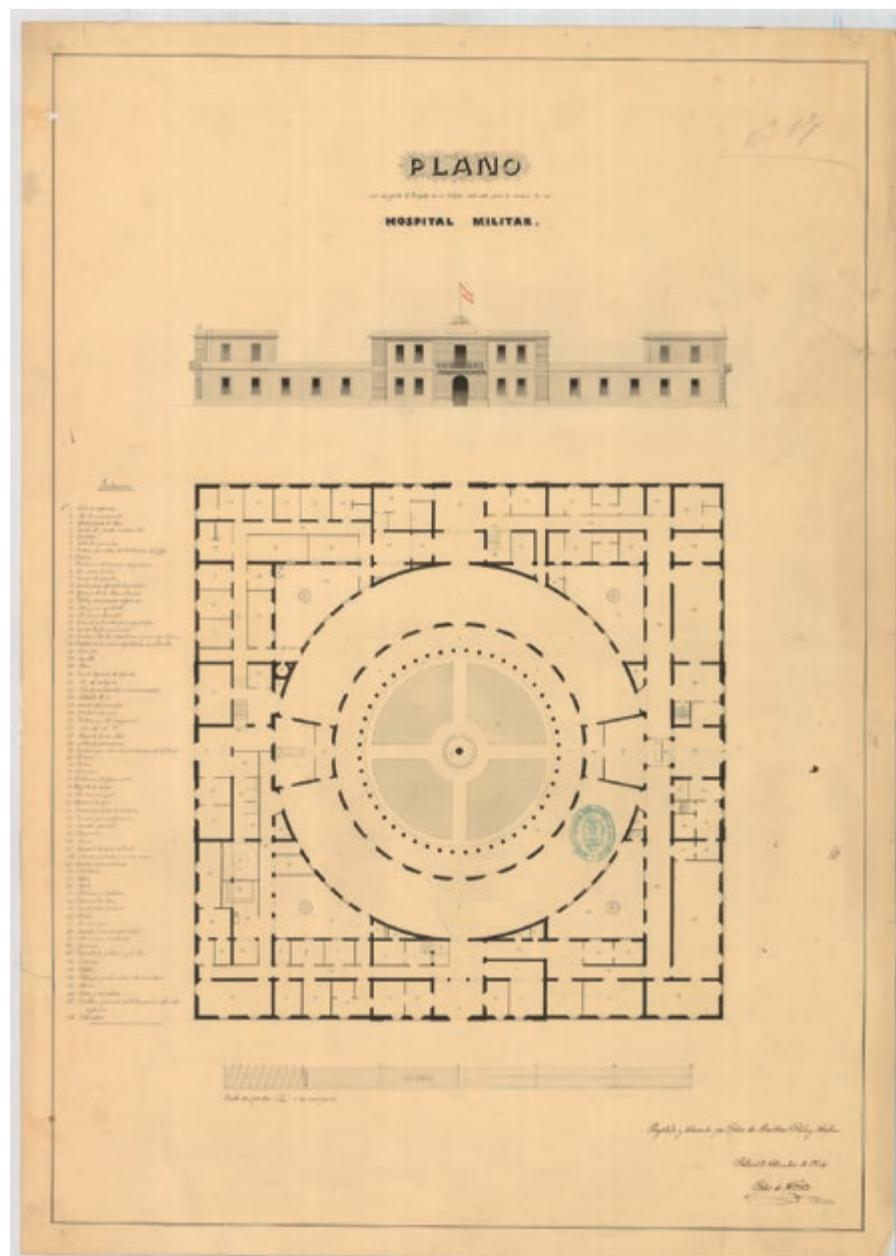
PLANO QUE COMPRENDE EL PROYECTO DE UN EDIFICIO DESTINADO PARA EL SERVICIO DE UN HOSPITAL MILITAR. *Planta baja y alzado*. Pedro de Alcántara Peña y Nicolau, 3 de septiembre de 1854. AGMM. IB-12/05.
